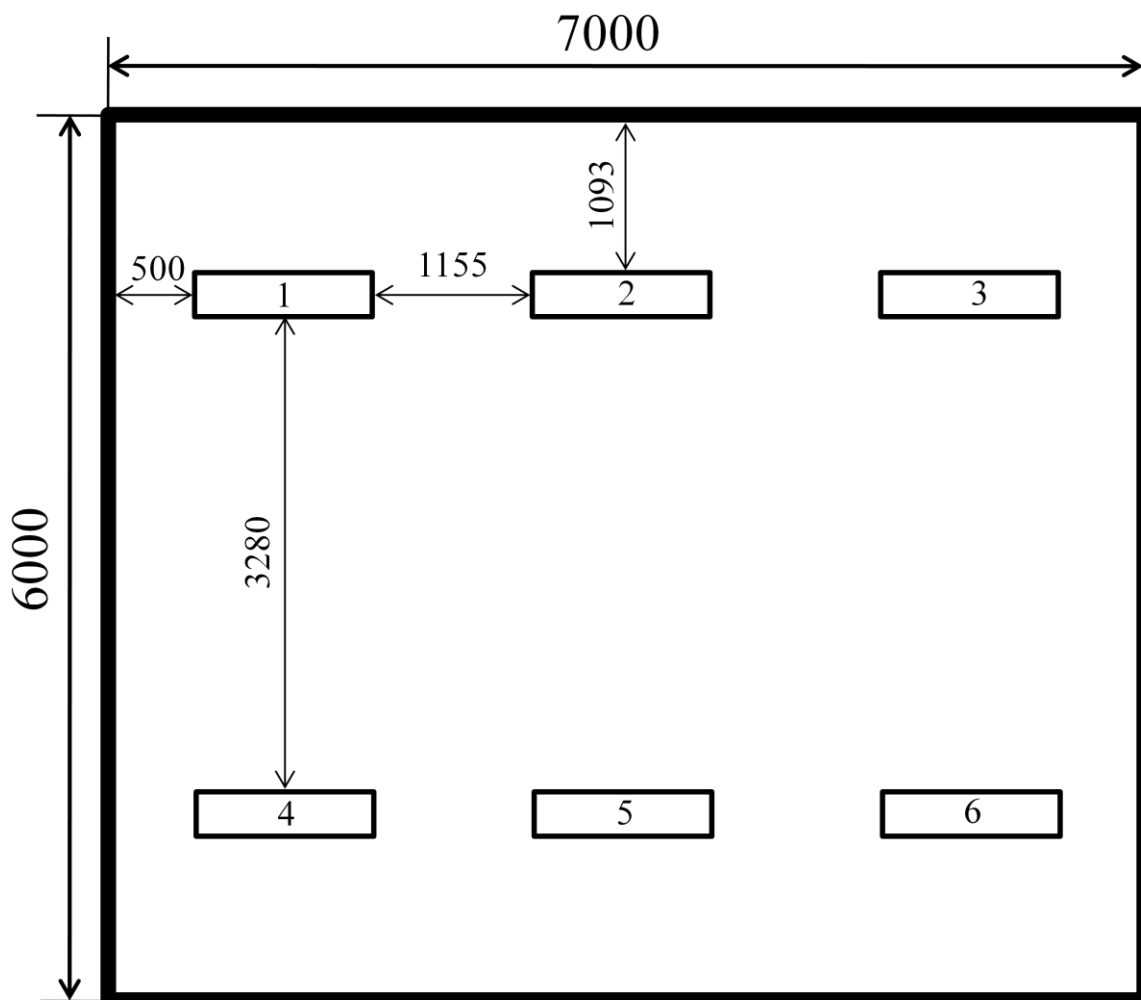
План помещения и размещения светильников с люминесцентными лампами.
